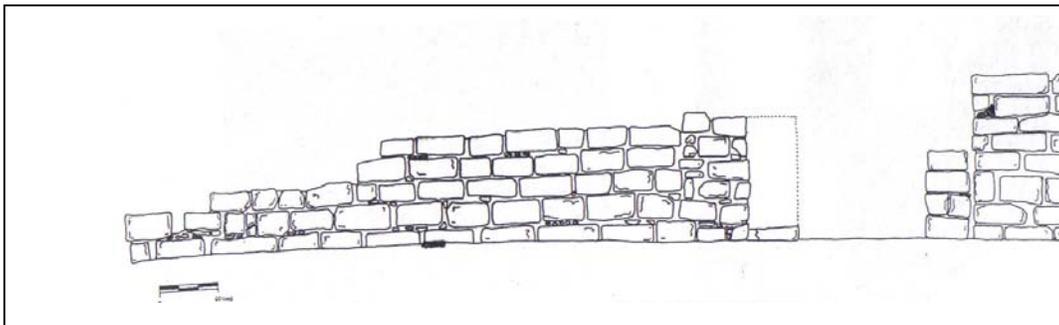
Estructura 5D16. Alzado del Muro Norte del Cuarto 1, visto desde el Sur.
